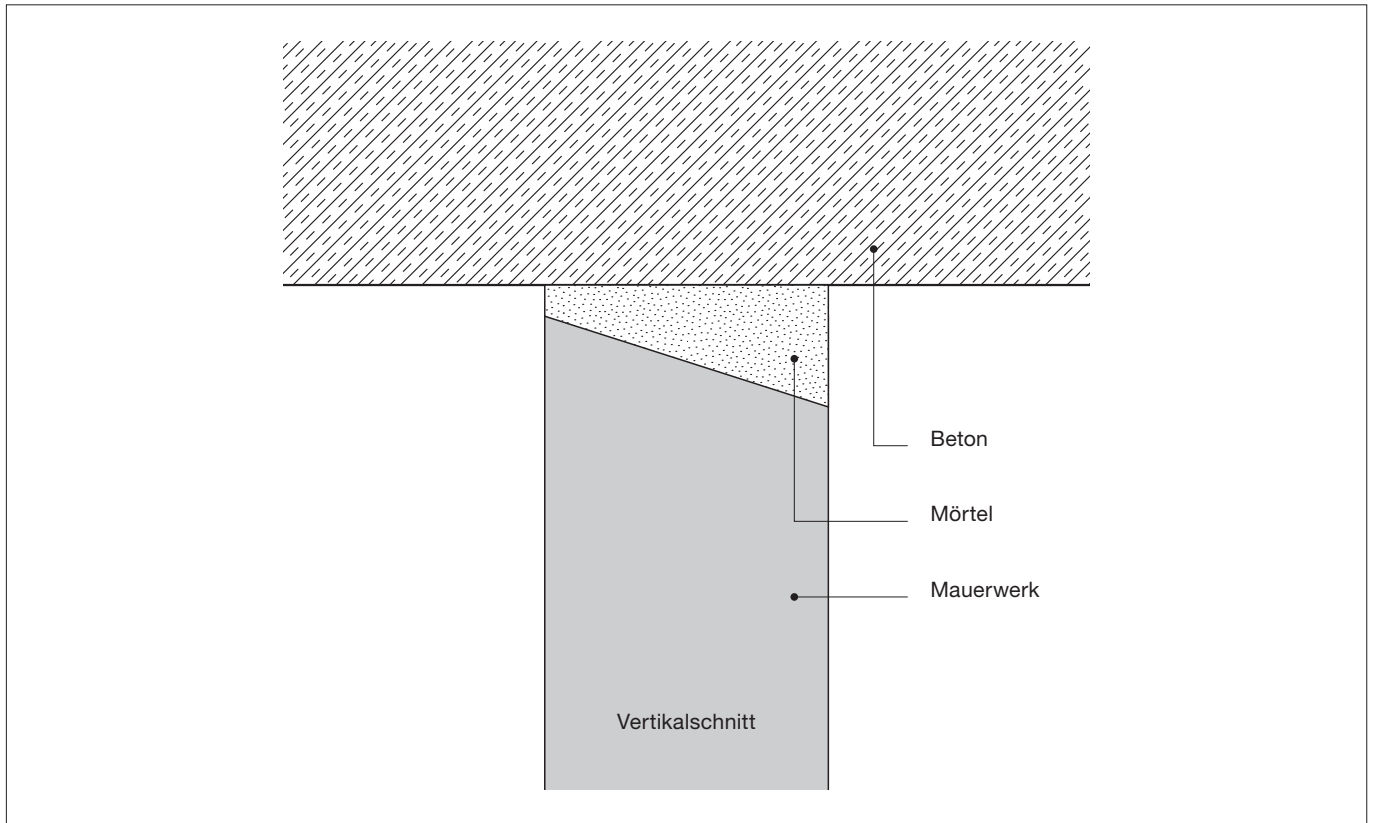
Anschlüsse Wand-Decke tragender oder nichttragender Massivwände aus Porenbetonmauerwerk
